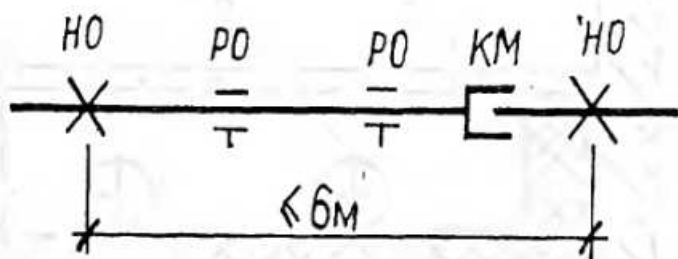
Монтажна схема трубопроводу PVC - С з муфтовим компенсатором теплових видовжень: РО - рухома опора; НО - нерухомі опори; КМ - компенсаційна муфта
